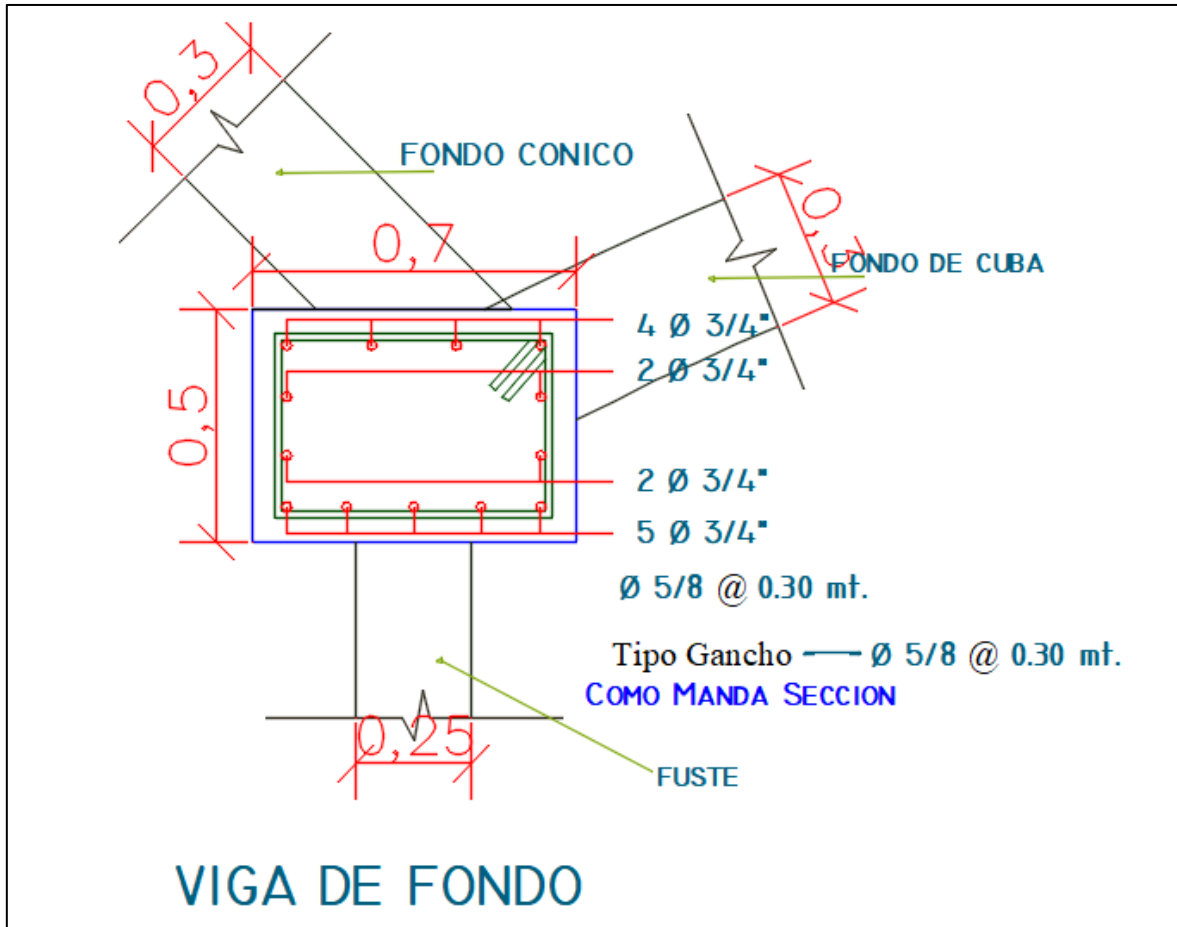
Plano de detalle de distribución de acero de la viga de fondo.
